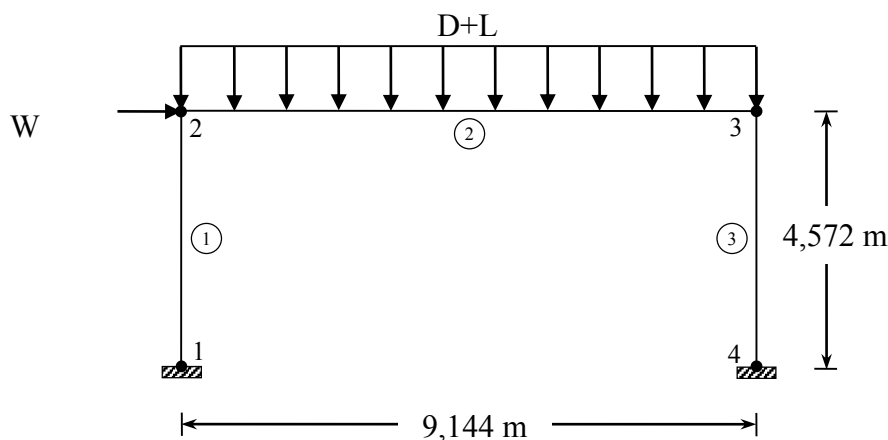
Pórtico plano com três barras e ligações semirrígidas: geometria, carregamento e discretização
